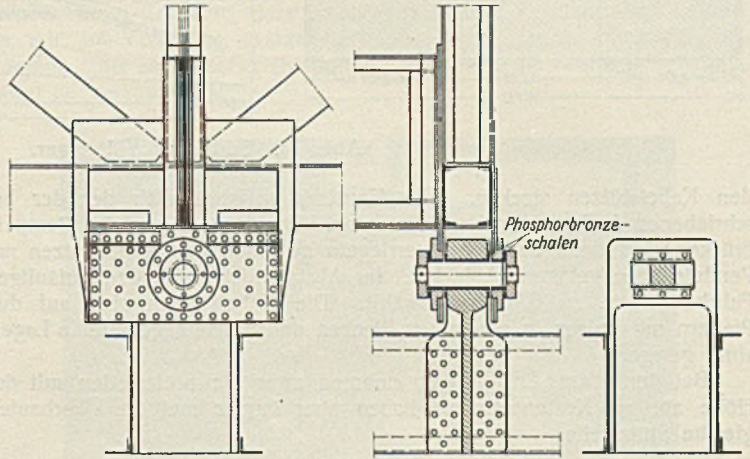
Bewegliche Lagerung der Hauptträger in den Querriegeln der Pylonen.
